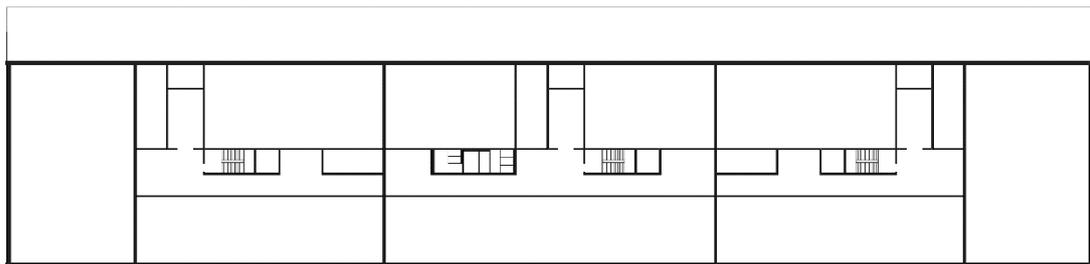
Vorentwurf Grundriss Regelgeschoss Kleingewerbe
